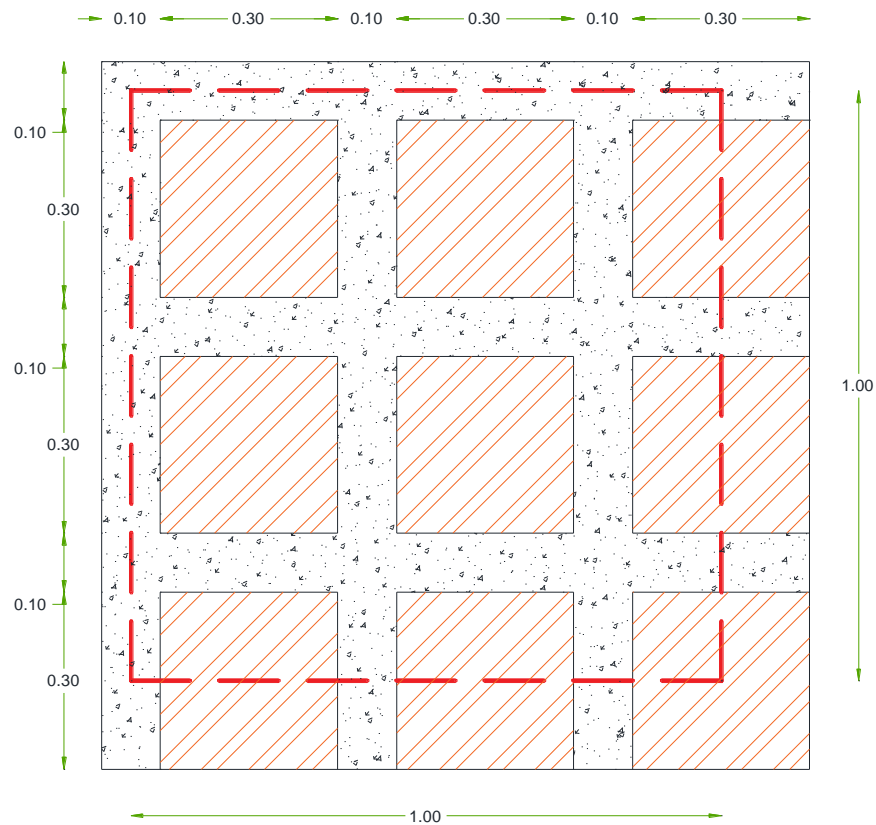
losa aligerada direccional. (Fuente Propia).
